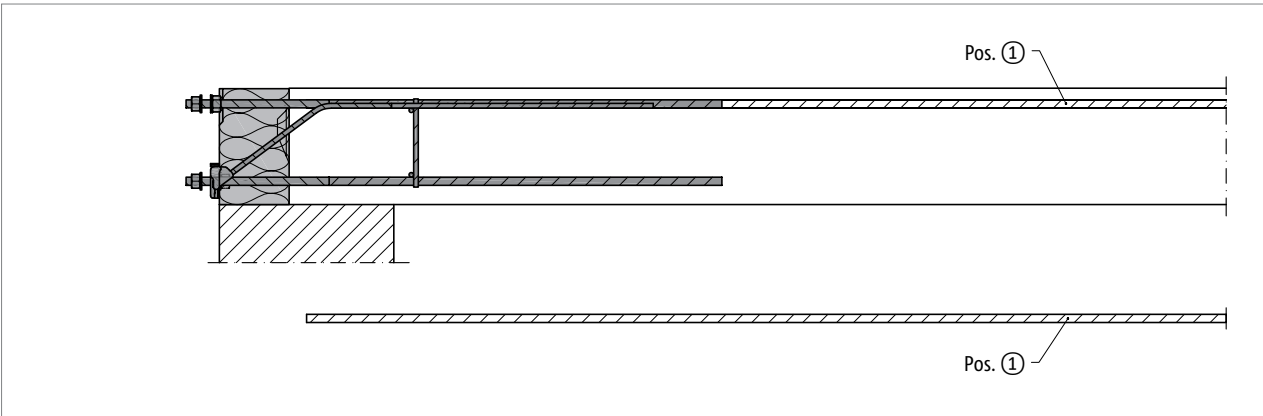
Schöck Isokorb® XT Typ SK-MM1-VV1: Bauseitige Bewehrung, Schnitt
